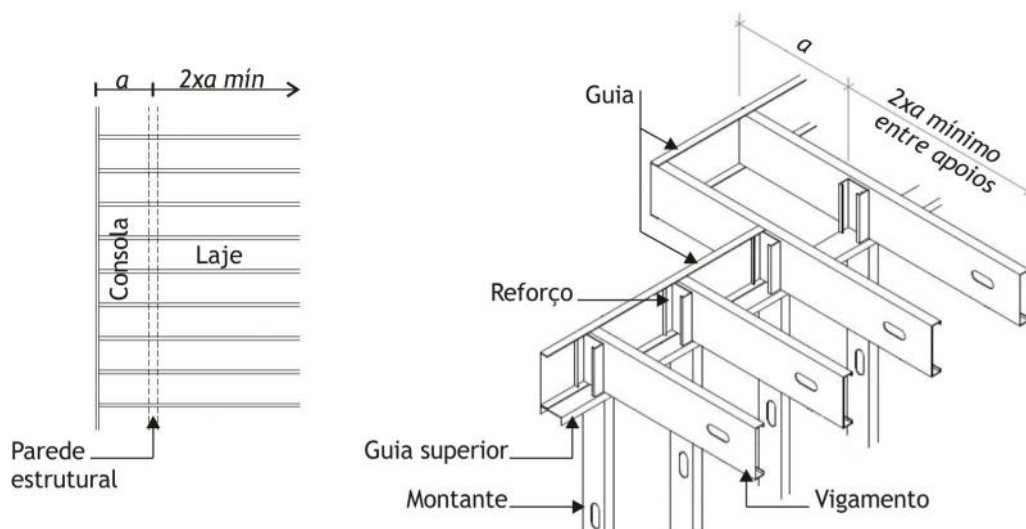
Pormenor construtivo da laje seca. Adaptado de: ConsulSteel, 2002.
